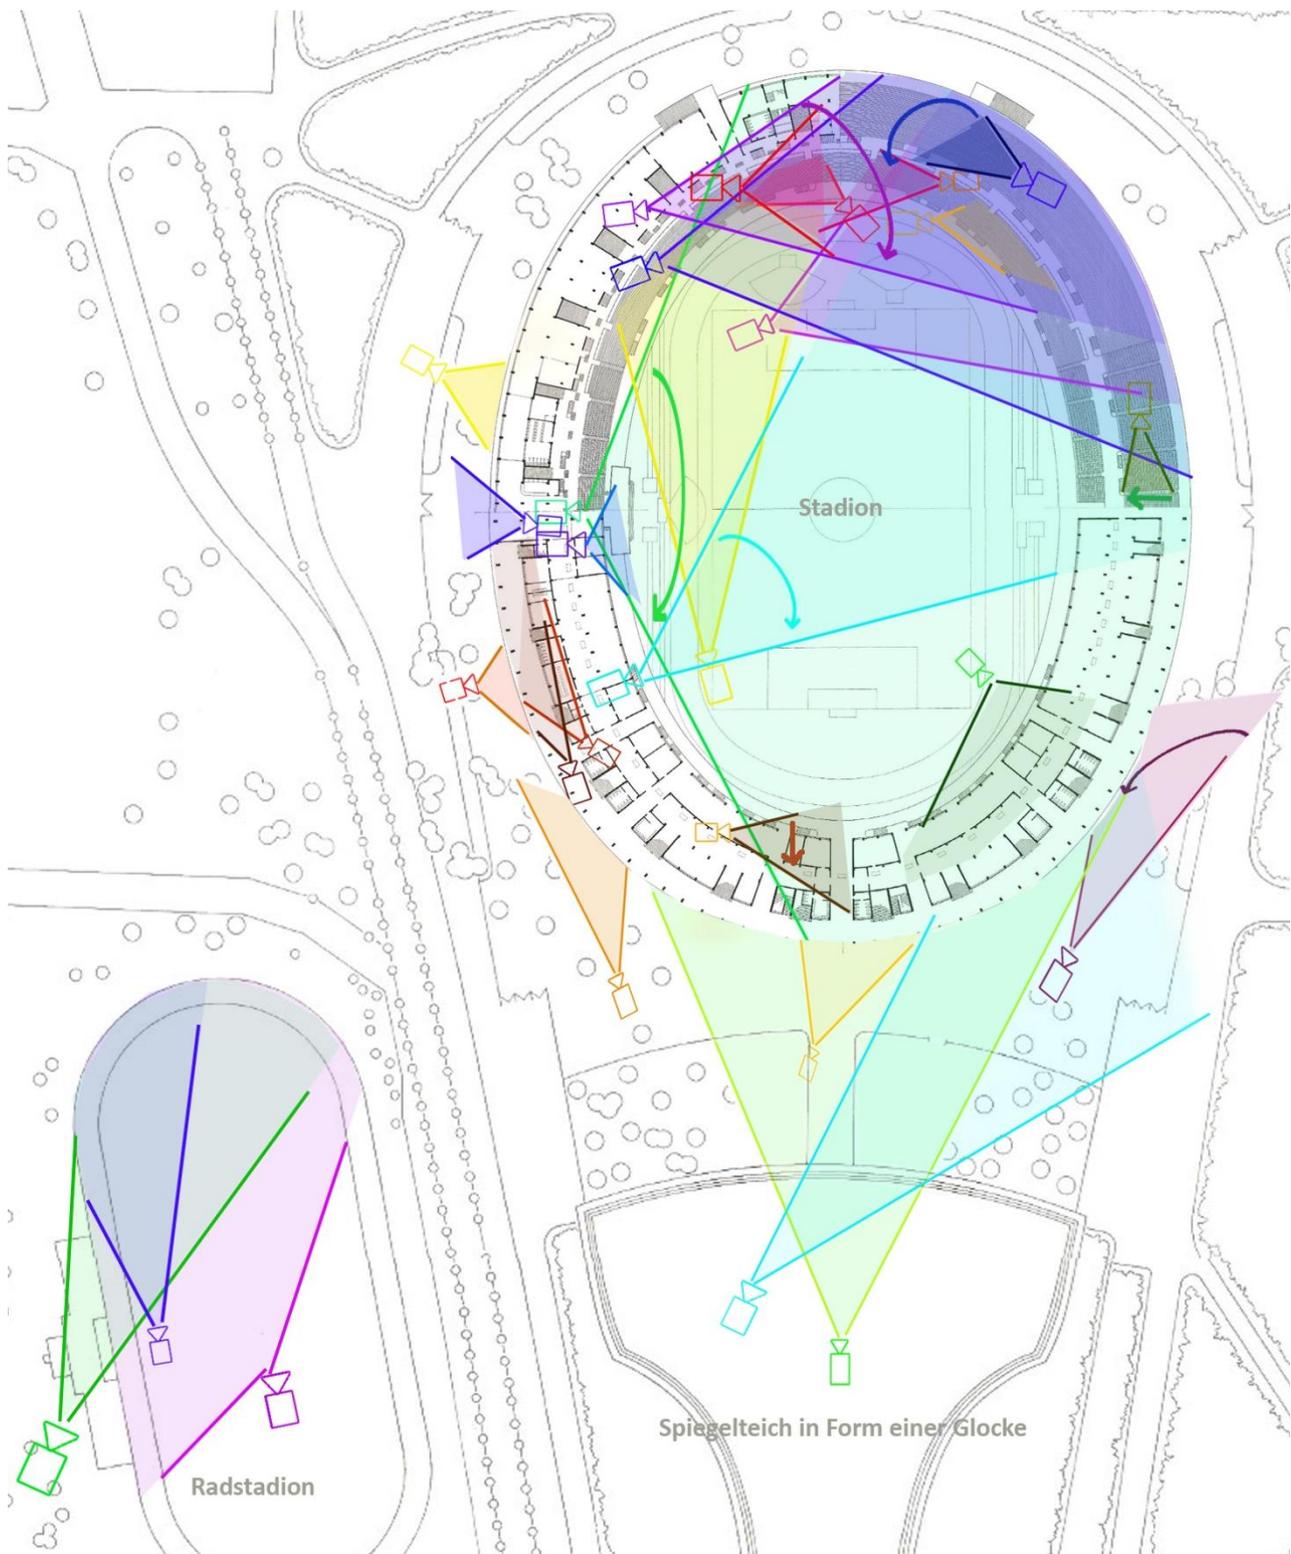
zeigt den Lageplan und den Grundriss des Ausführungsentwurfs des Stadions mit dem vorgelagerten Spiegelteich.
